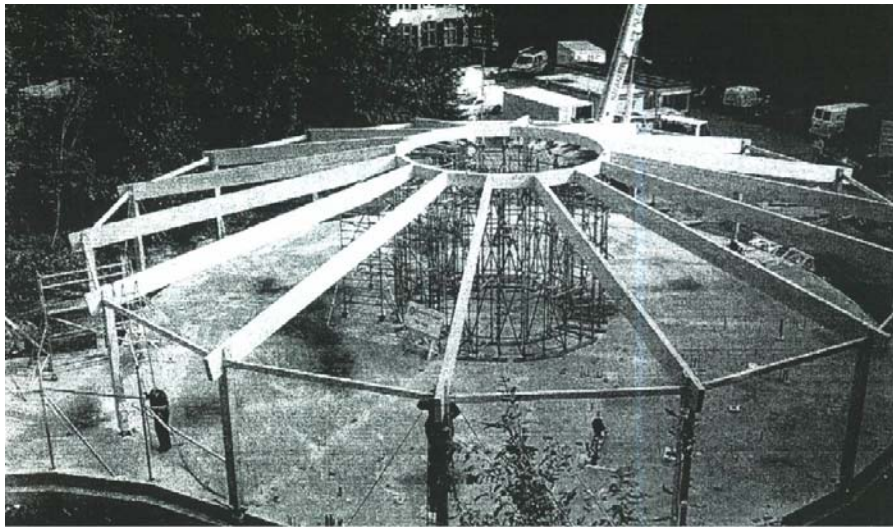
Foto de uma construção circular com pórticos planos radiais. Fonte: LEIJTEN(2001)
